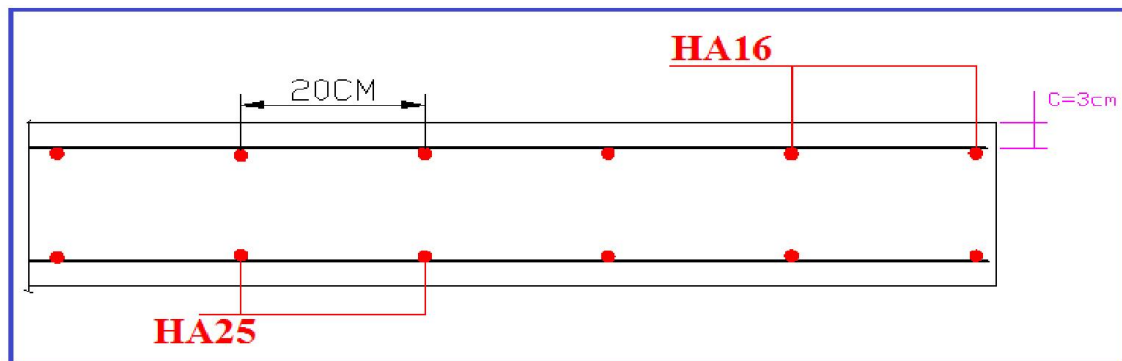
Ferrailage transversale de l'hourdis.
